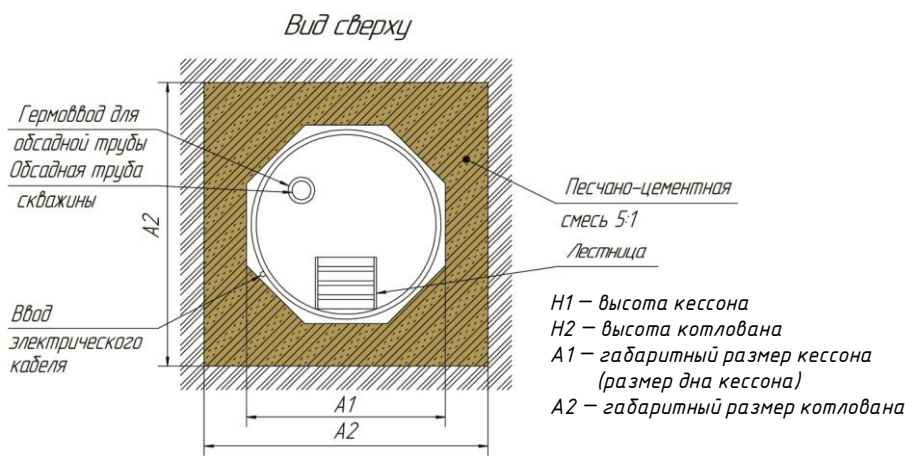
Обозначение габаритных размеров кессона КЛЕВЕР в разрезе (вид сверху)
